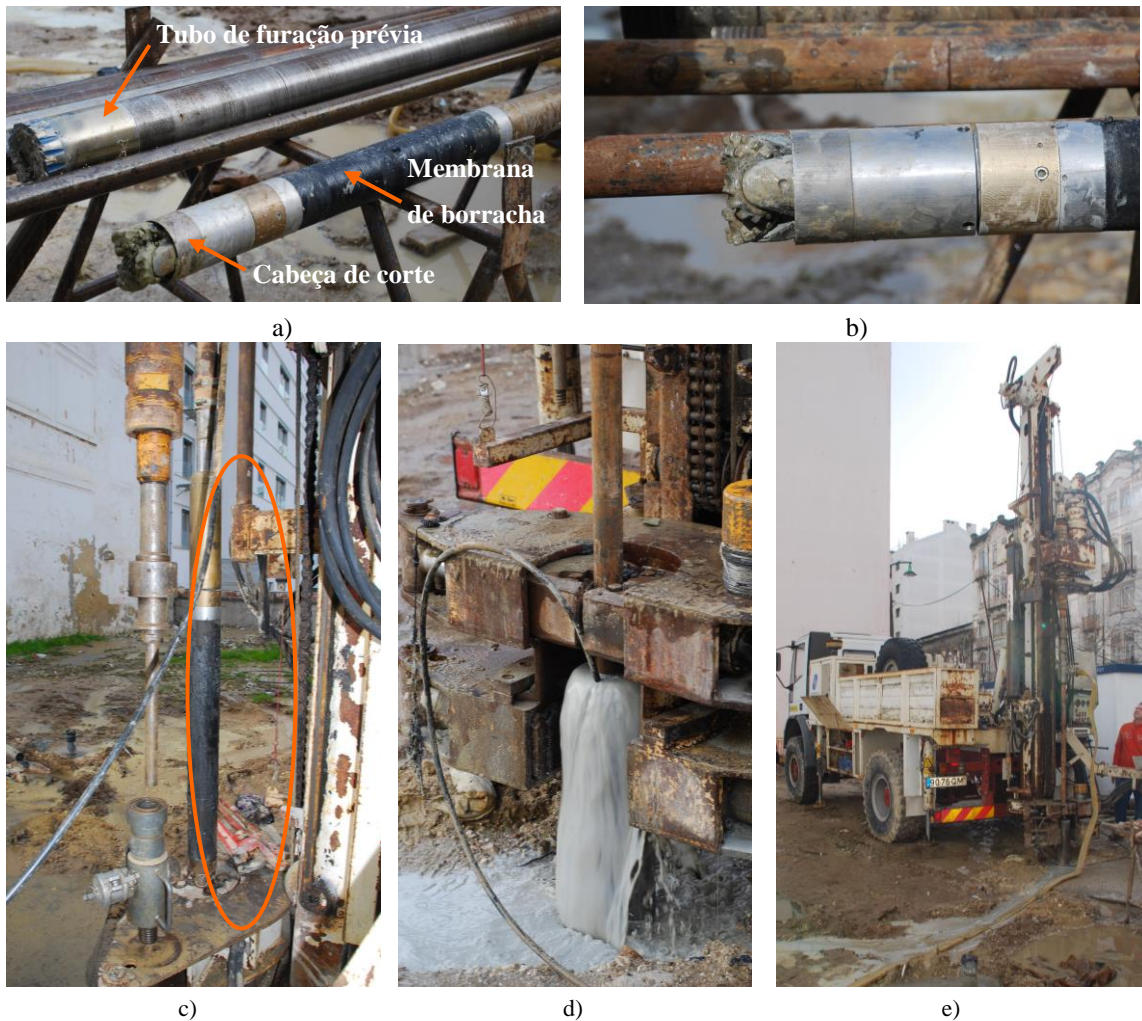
Alguns aspetos da realização dos ensaios: a) aspeto geral do pressiómetro; b) pormenor da ferramenta de corte (*rock roller bit*) utilizada; c) pressiómetro instalado na máquina de furação; d) furação prévia; e) vista geral do local dos ensaios.
